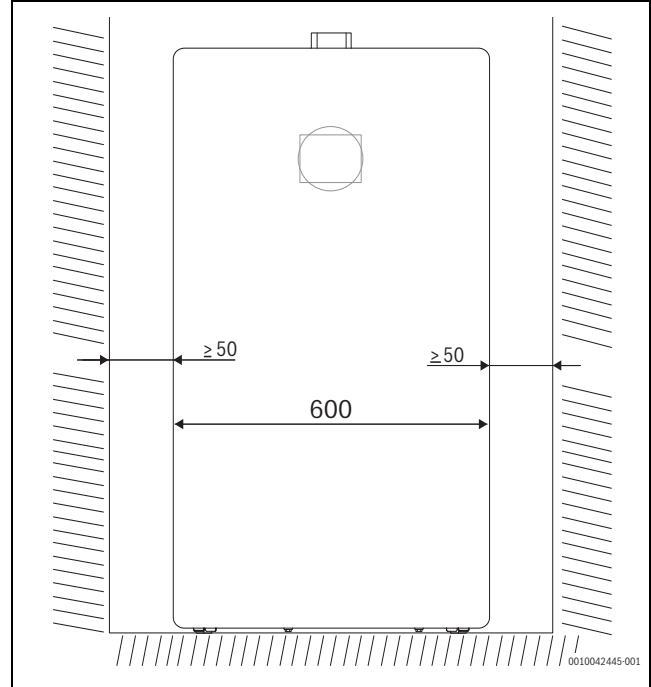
Vue de face : dégagement latéral minimal par rapport au mur. Le dégagement par rapport aux autres unités est défini sur 0 mm.
